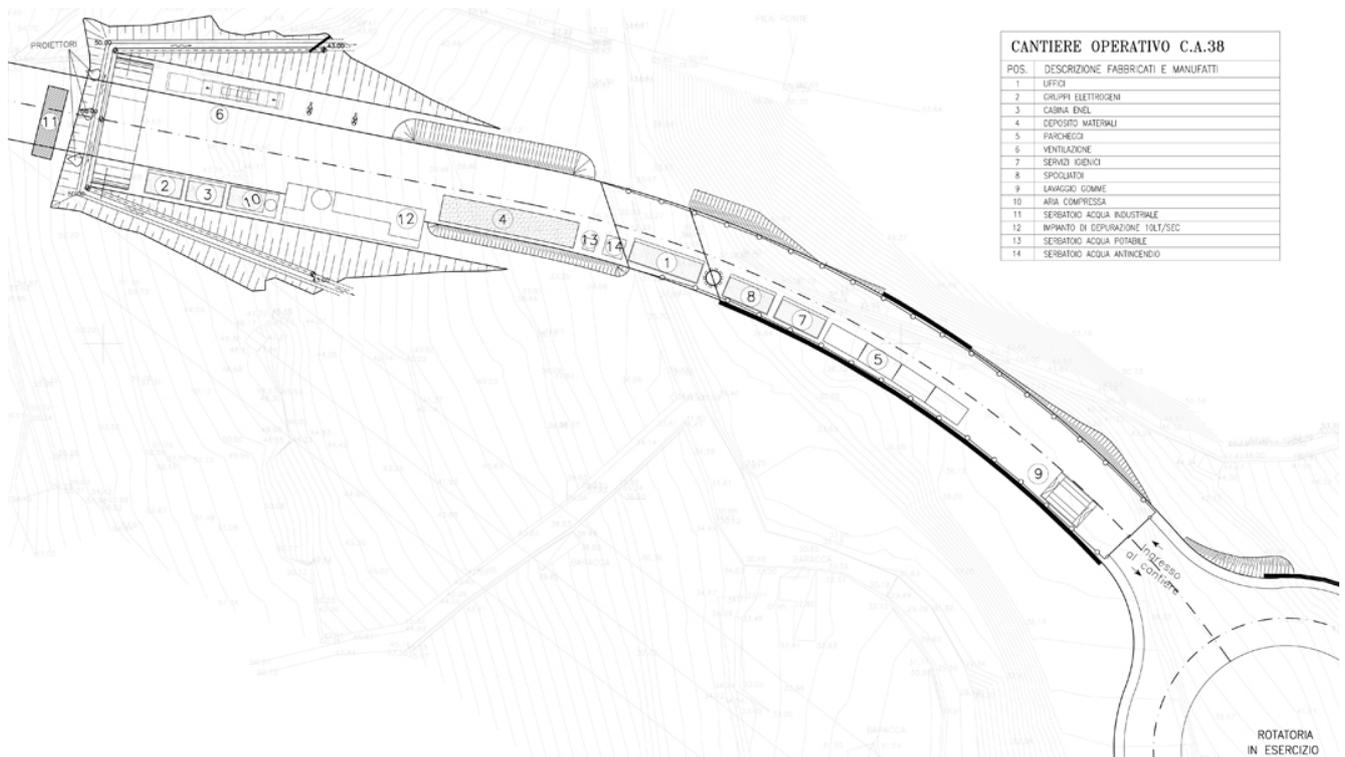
Stralcio della planimetria di progetto del cantiere CA38.
